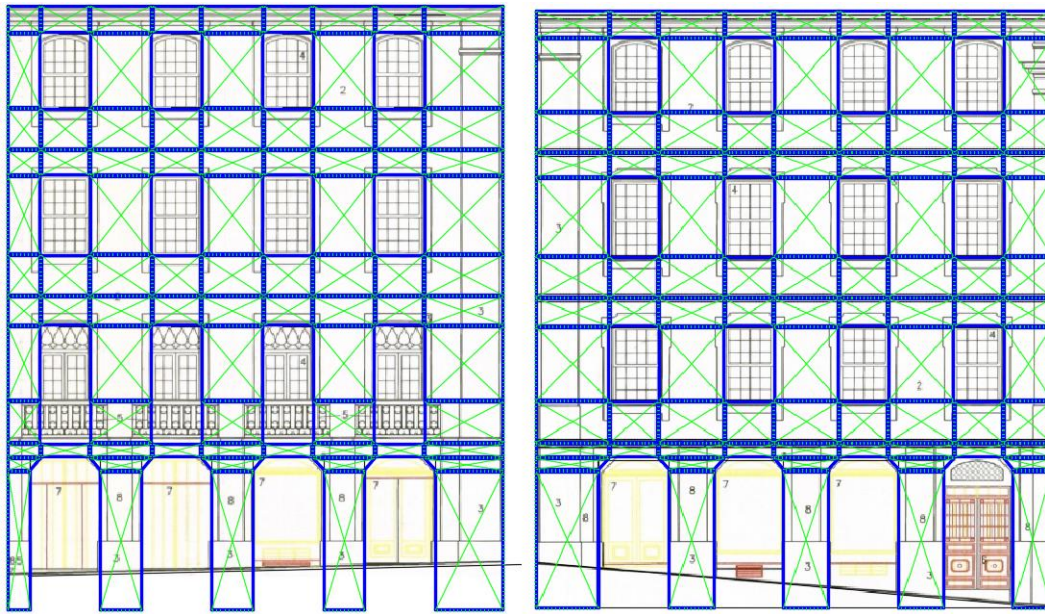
Malha utilizada para definir as fachadas da Rua dos Fanqueiros e da Rua da Assunção respetivamente
